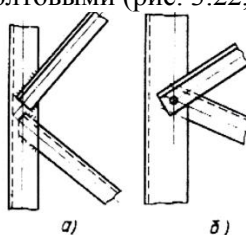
Соединение стержней-раскосов с поясом опоры: а – внахлест; б – болтами.
